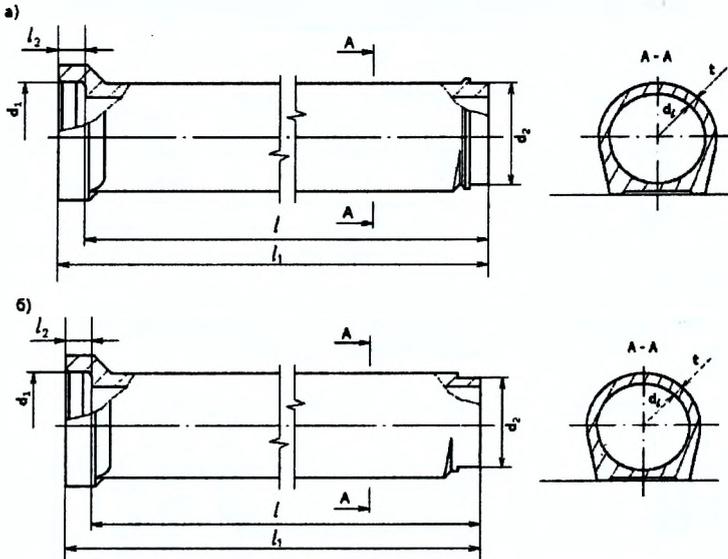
Общий вид труб типа ТΠ (БТΠ) – труб железобетонных (бетонных) цилиндрических раструбных с подошвой
